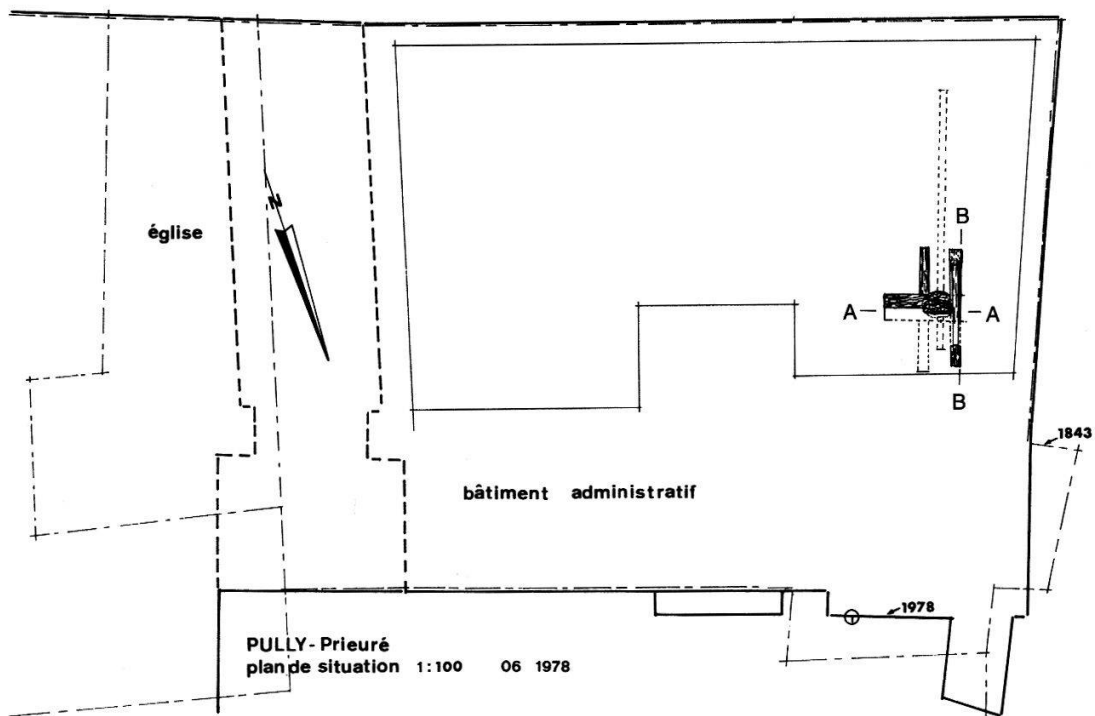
Pully - Bâtiment administratif. Plan de situation et plan du bâtiment d'après le cadastre de 1843. Position des coupes.
